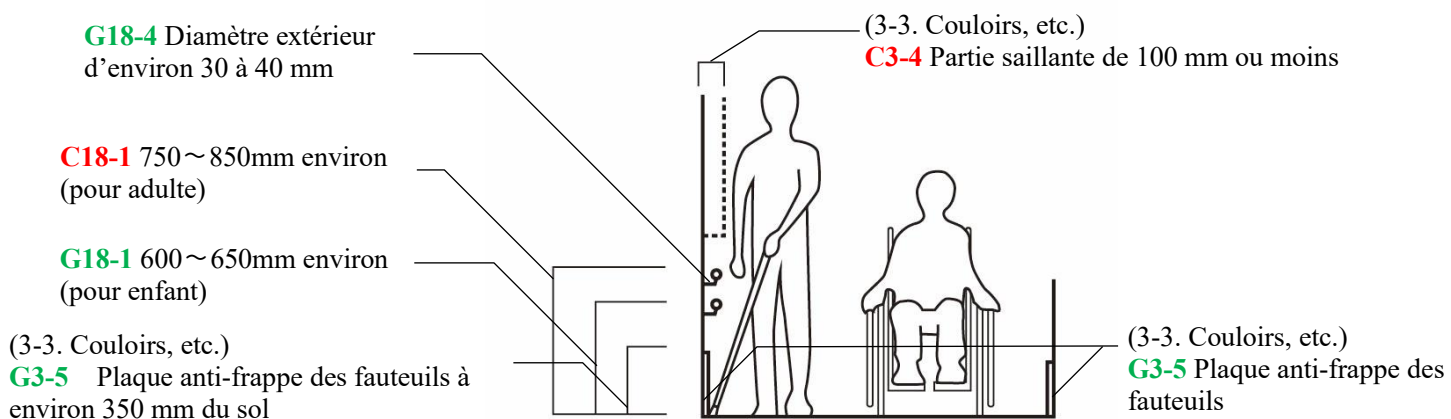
2 Balustrades (exemple de l'installation mural)
